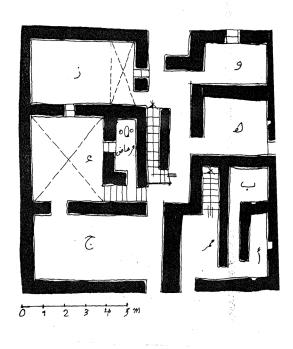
منزل مهدى عواضة الدور الأول – مسقط أقتى ـ
